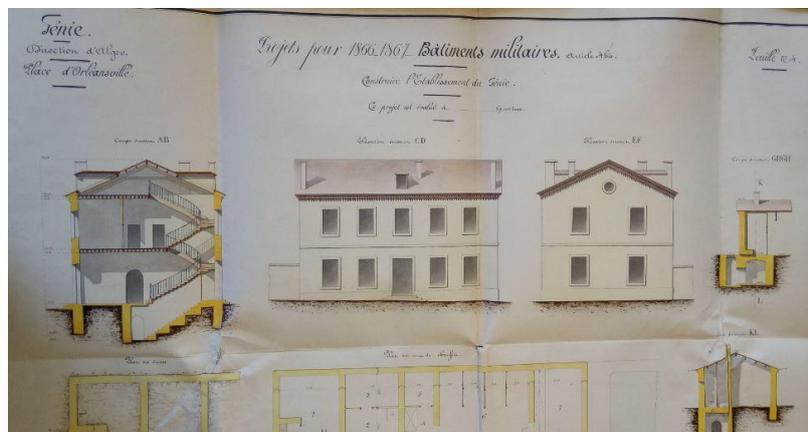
Plan De Construction D'un Etablissement Du Génie Militaires
